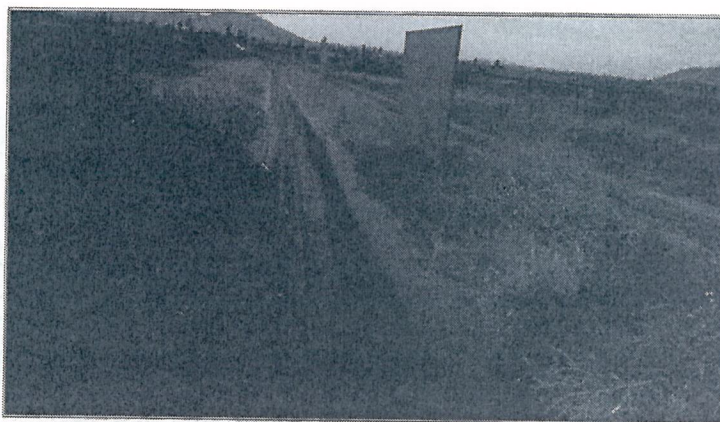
Estado actual Canal perimetral norte de poniente a oriente.
